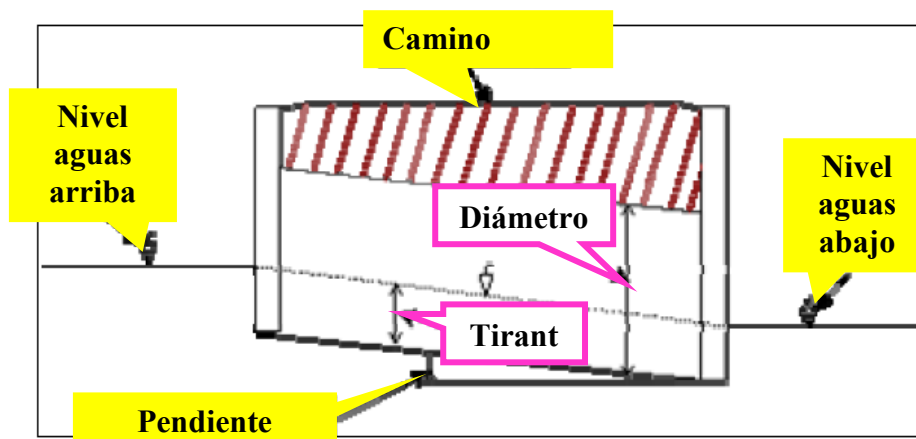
Sección longitudinal de las alcantarillas y variables de diseño
